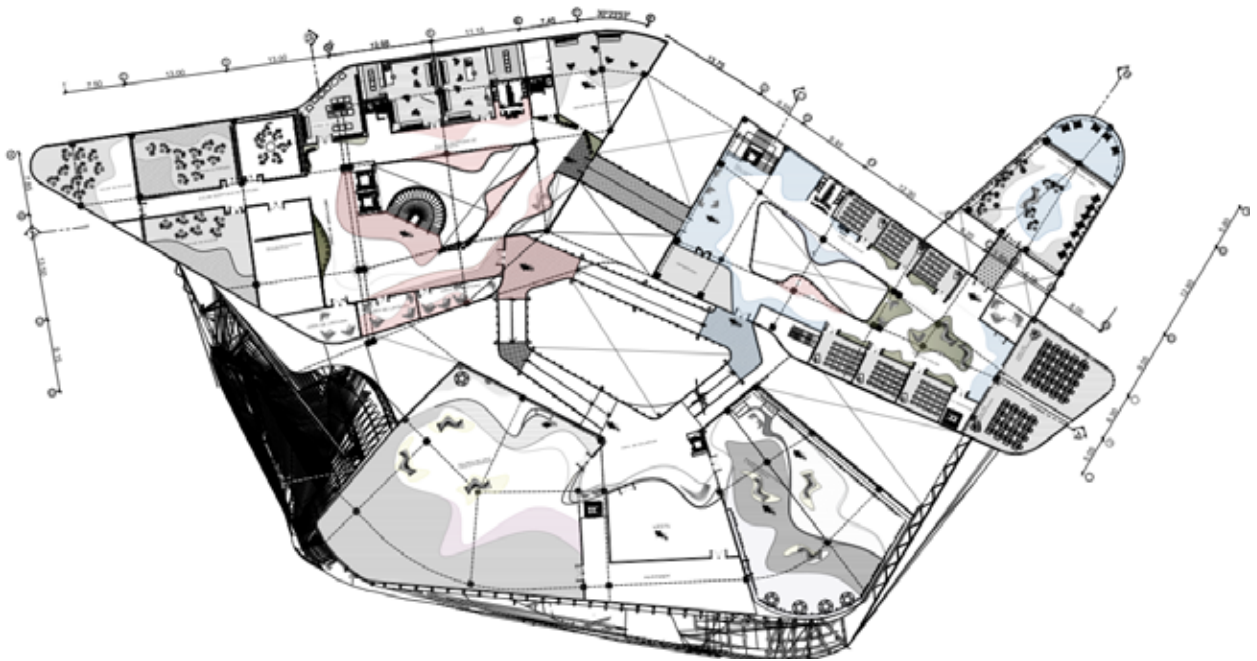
Plano Planta segundo piso de escuela de artes. (2017)
